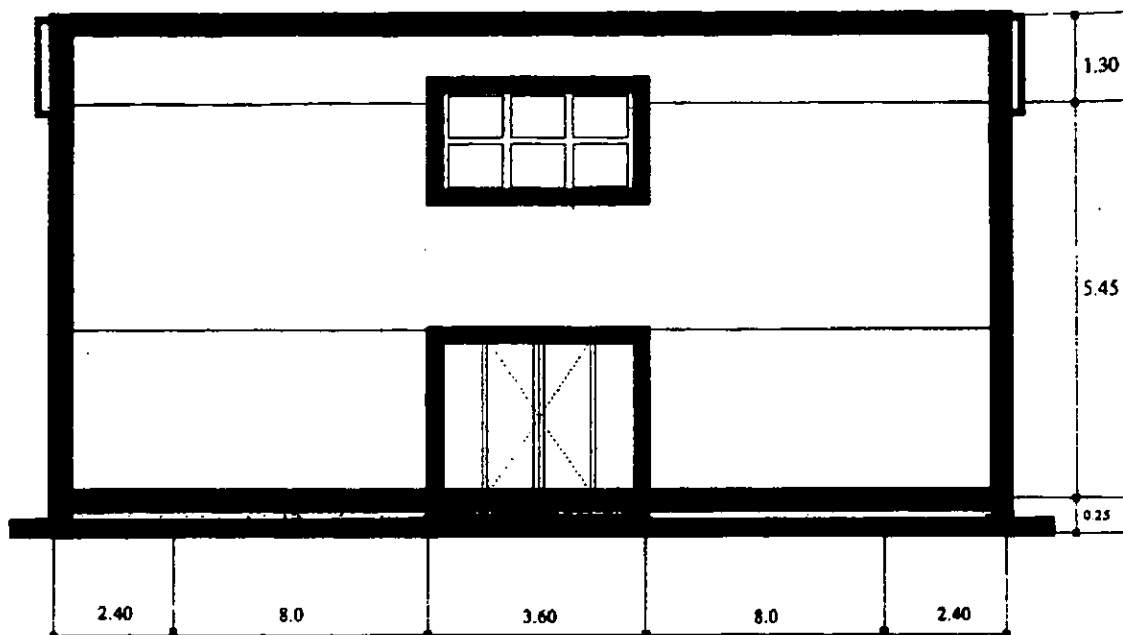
Fachada Sur del Laboratorio de Ingeniería Química.
